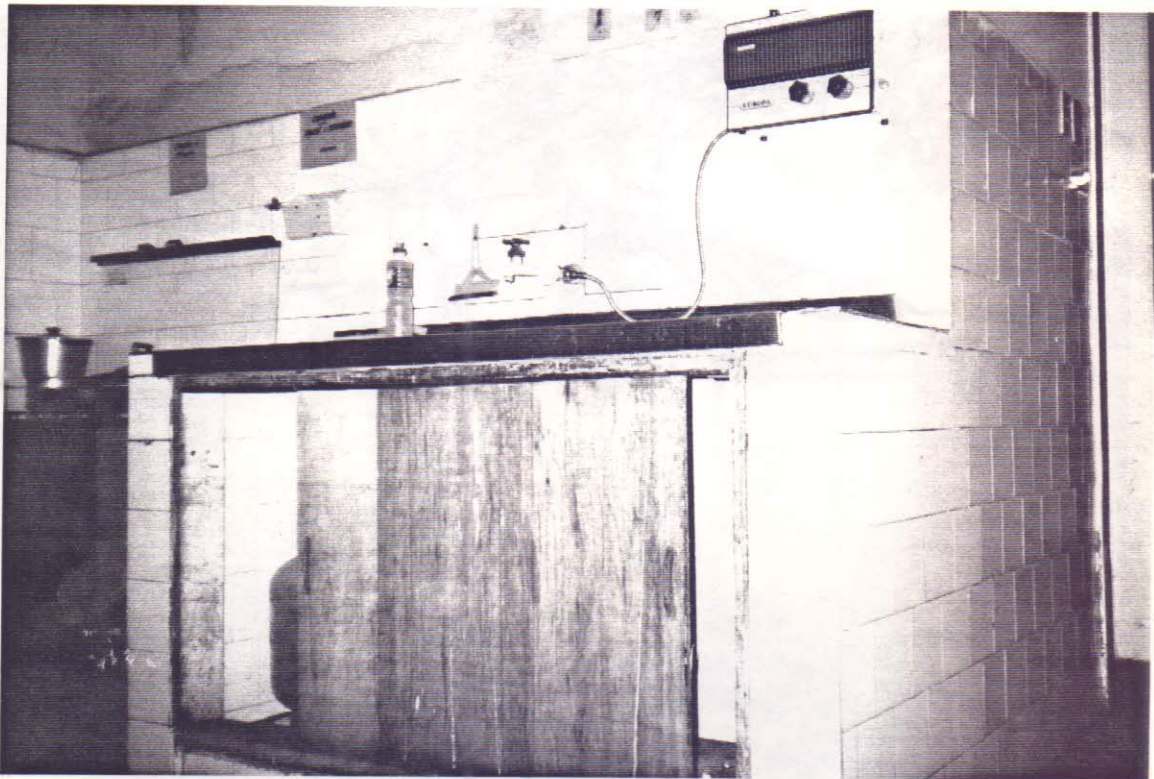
Bancada da cozinha da REU da Rua Waldery Uchoa, 140.
